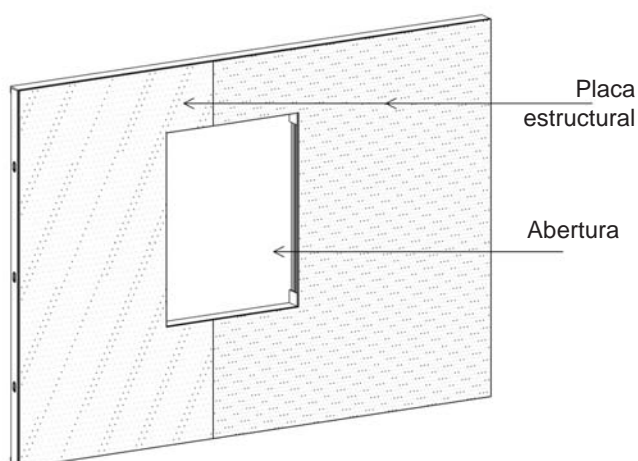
Colocación de las placas estructurales en paneles con aberturas.
